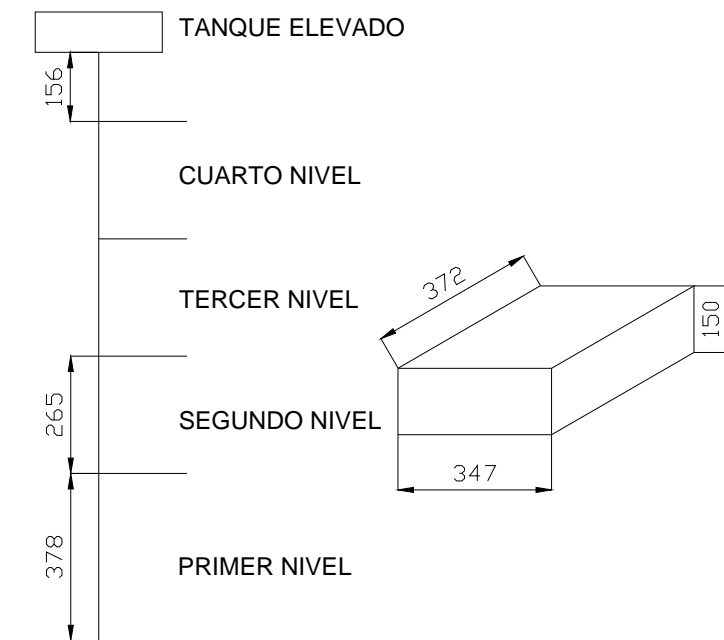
Esquema y dimensiones del tanque elevado en cm.
